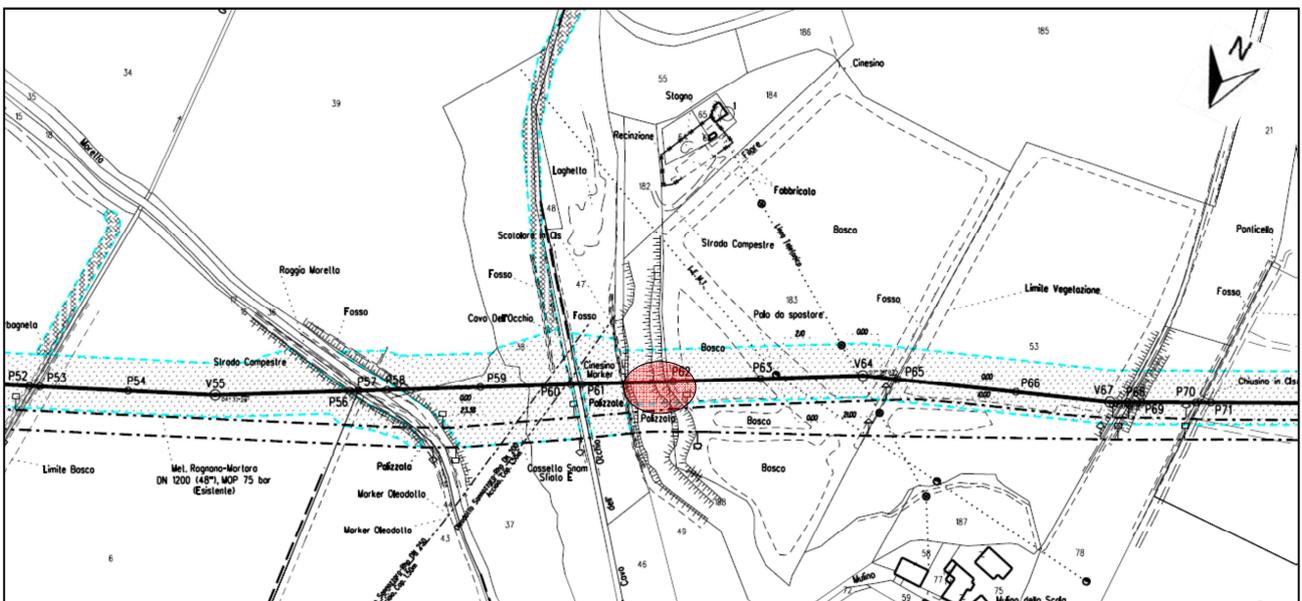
Localizzazione Area Test VEP 06 VG su planimetria catastale
